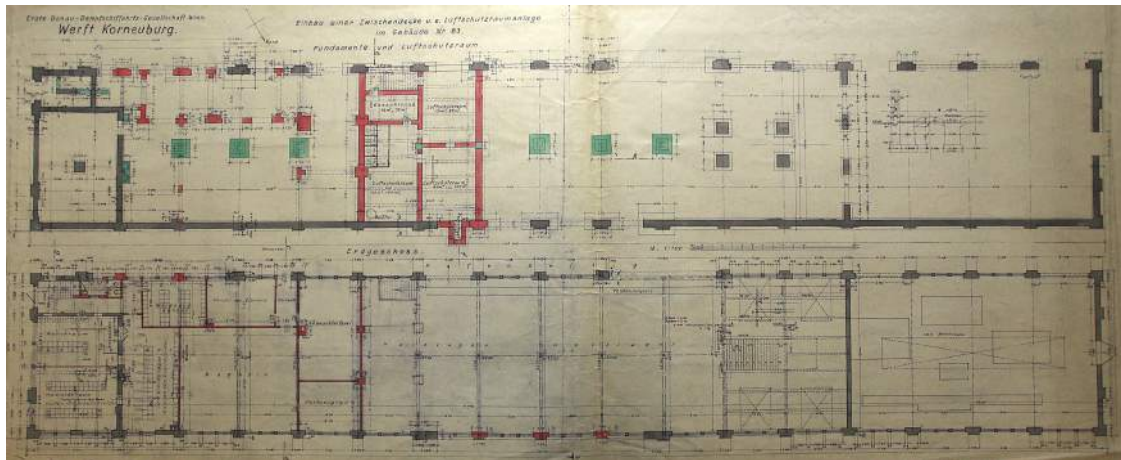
Einbau einer Zwischendecke und einer Luftschutzanlage im Jahr 1942
